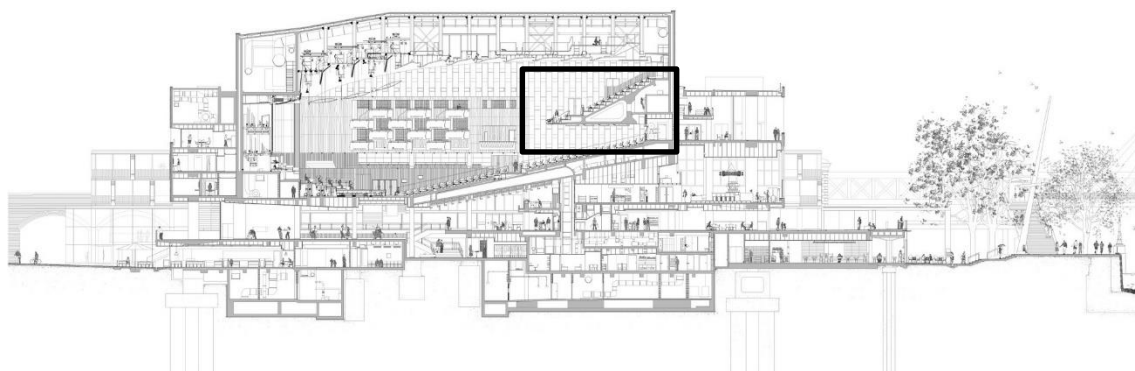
Vista em corte da viga caixão triangular que suporta a laje da bancada em consola do Royal Festival Hall [19].
